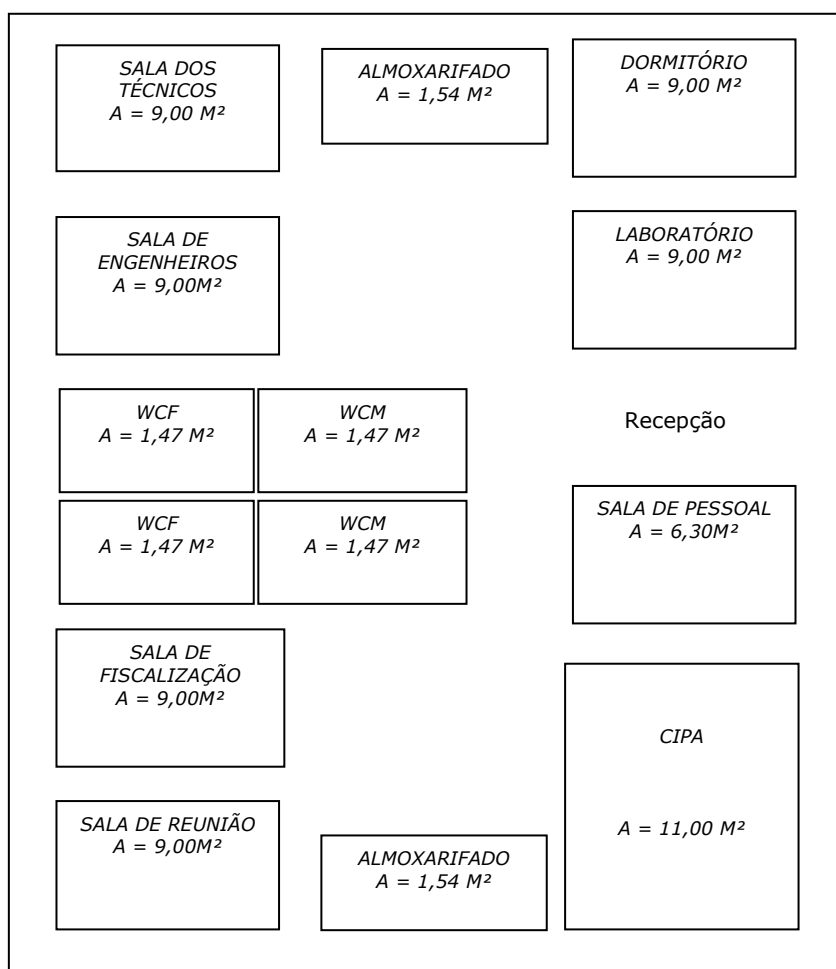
Layout do canteiro de obras.
